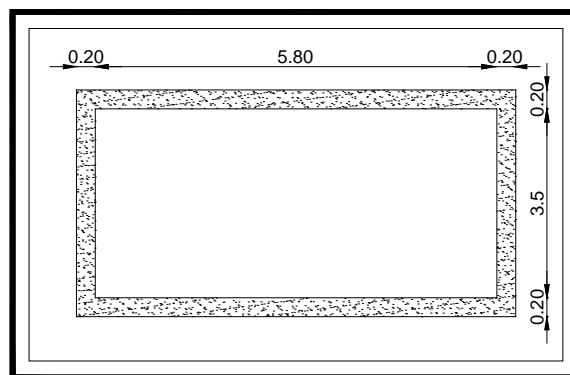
Vista en planta del Tanque Séptico.
